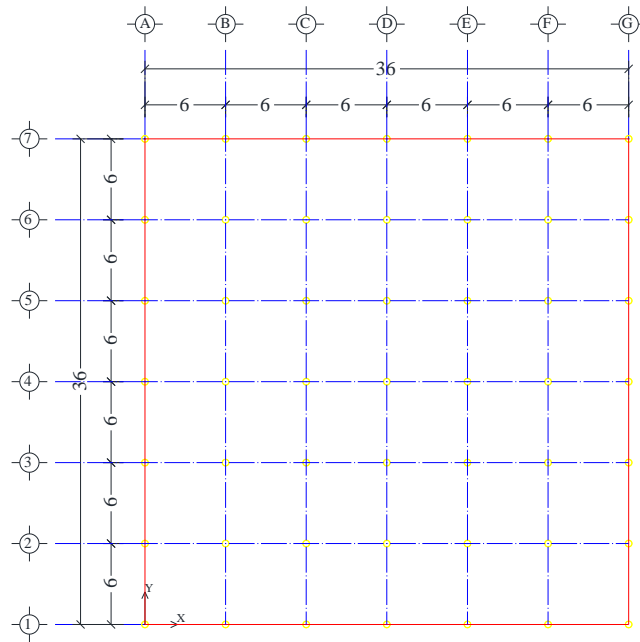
Vista en planta de los modelos de 3, 5 y 7 niveles.
